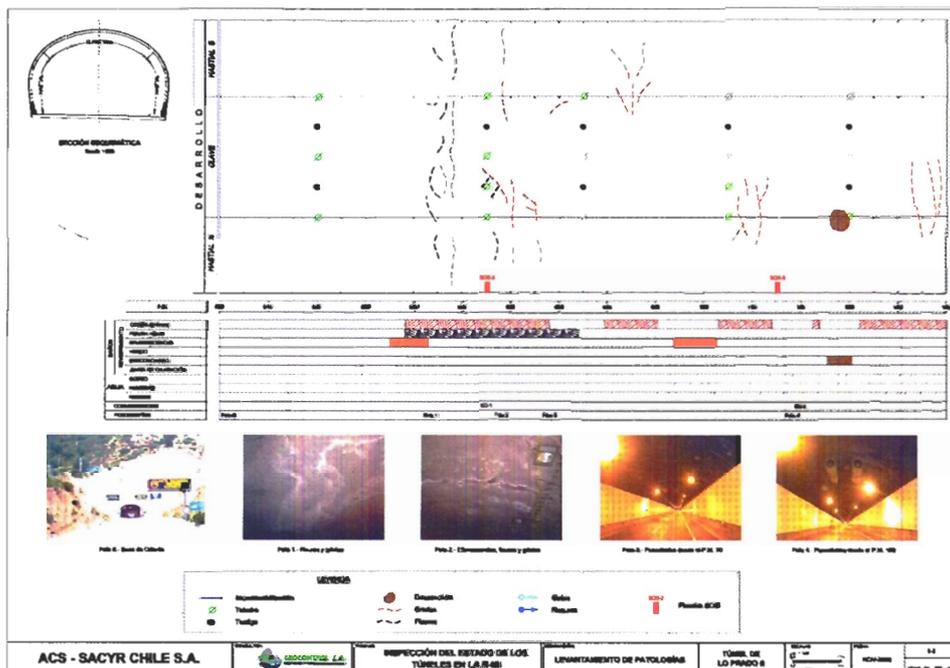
Ejemplo de levantamiento de patologías realizado.
